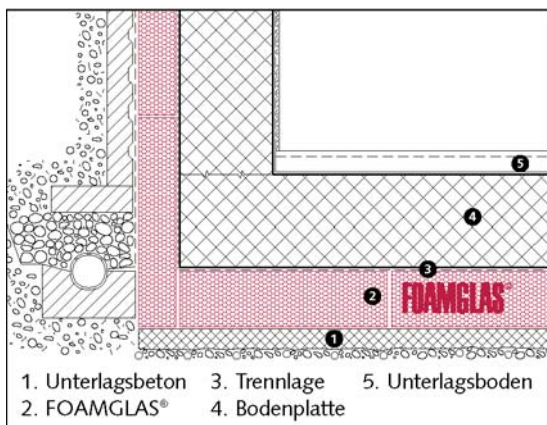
Detailplanskizze Foamglas Aussendämmung auf Wand und Bodenplatte (wie in Bauratgeber „Radon“)
